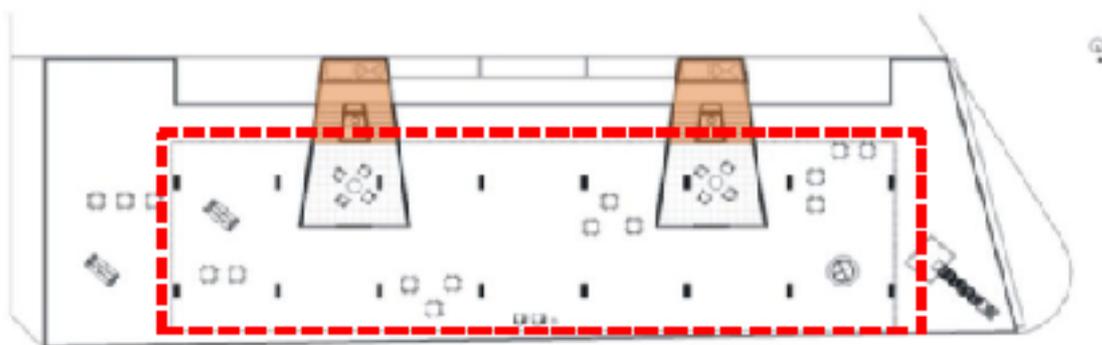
Planta do 5º Pavimento. Fonte: Carolina Chaves e Olívia Poliana, 2005.
